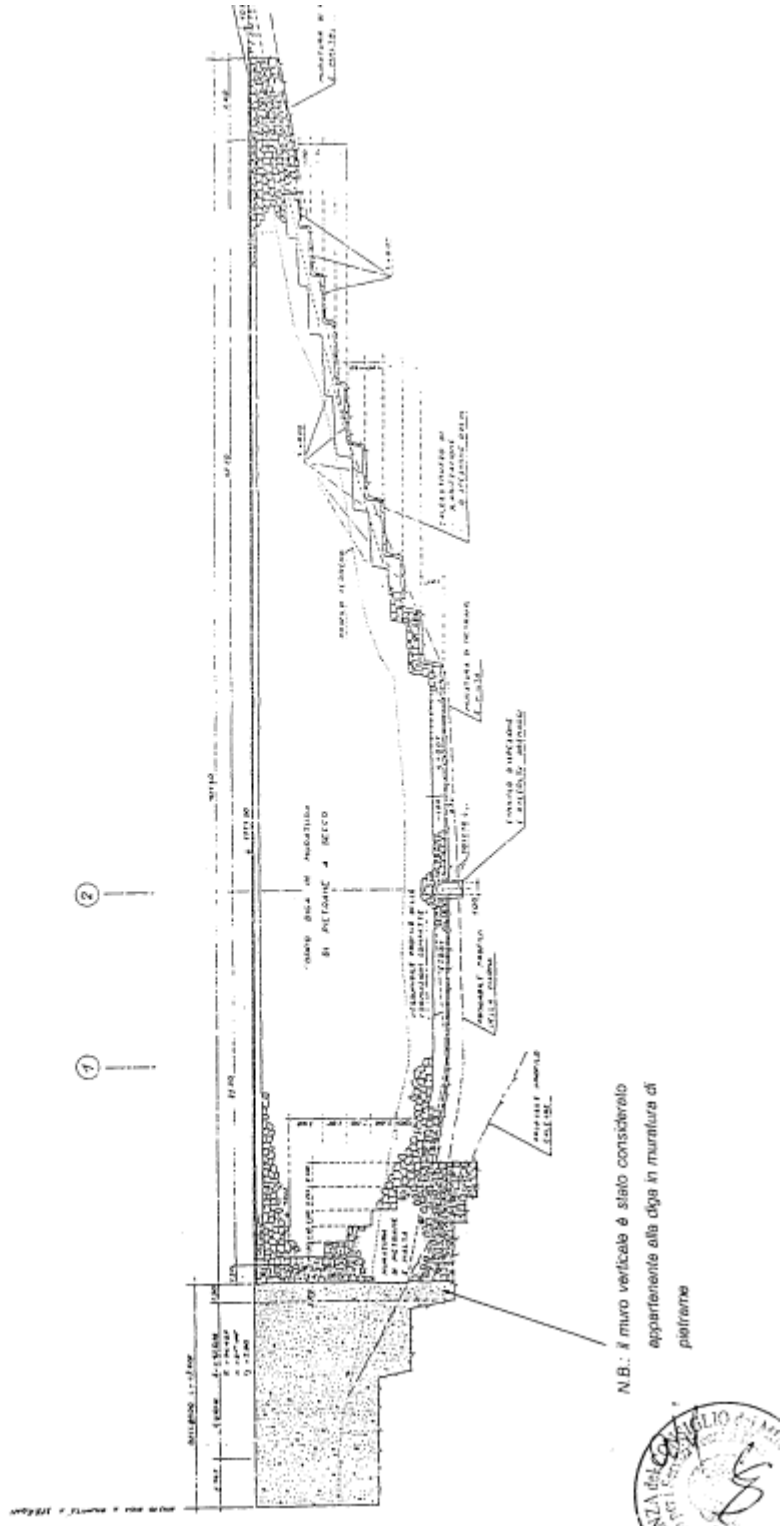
Invaso di Montagna Spaccata. Diga 3 in muratura di pietrame a secco. Profilo
